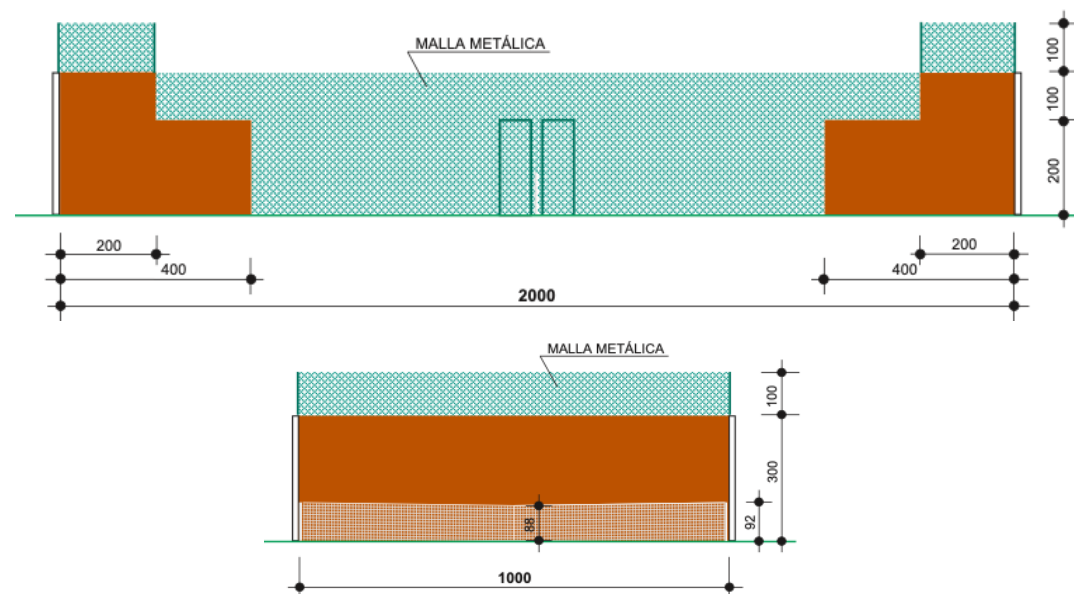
Alzado lateral (arriba) y alzado fondo (abajo) de las pistas (cotas en centímetros).
